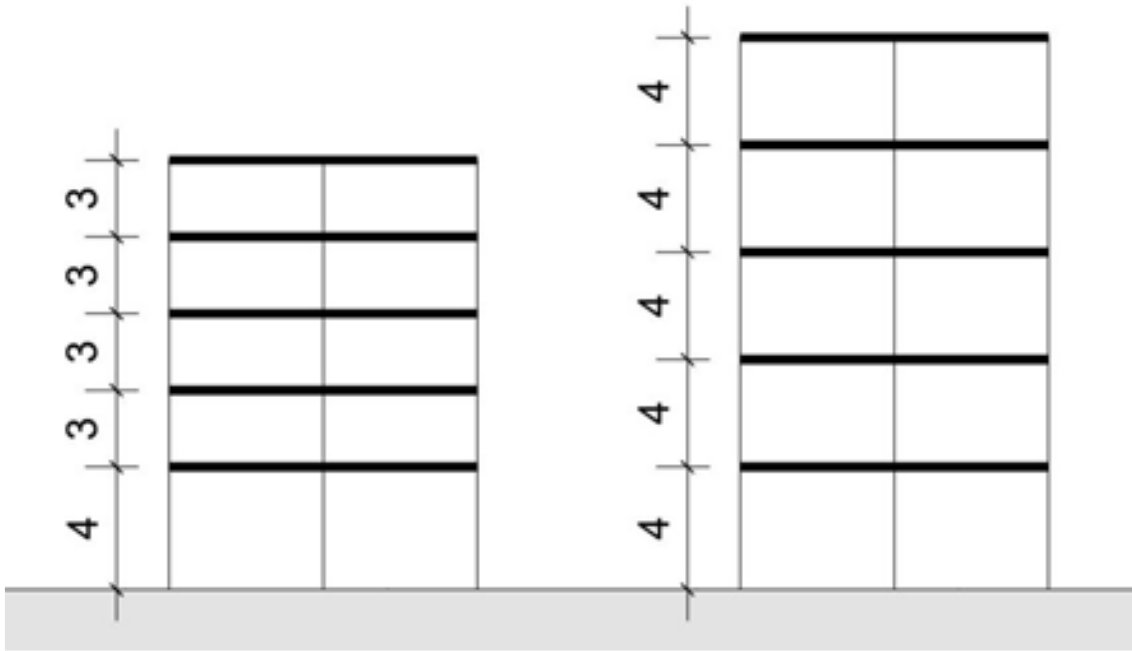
Edificio irregular (izquierda) y regular (derecha). El edificio de la izquierda posee una planta baja débil por el cambio de rigidez en esa planta relativa a las superiores.
